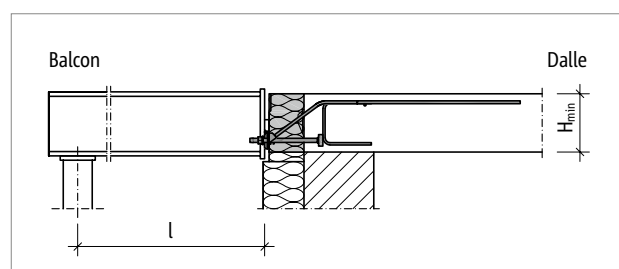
Schöck Isokorb® XT type SQ : système statique
